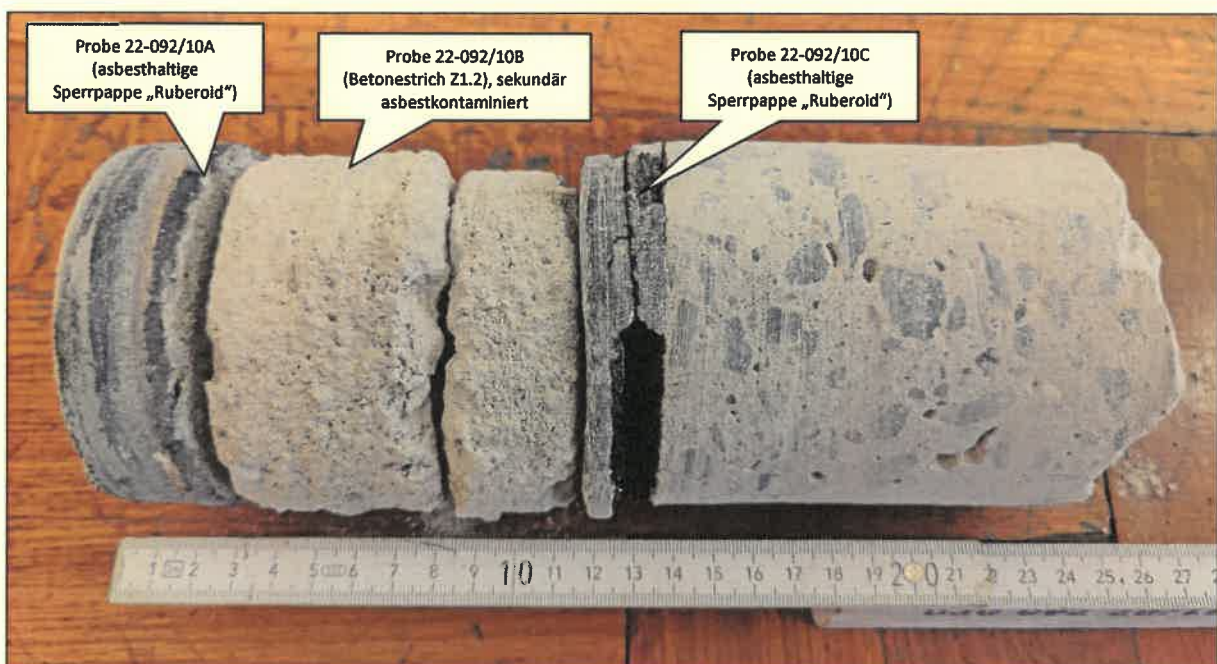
Anbau NW, Sportmethodisches Kabinett R 177 – Kernbohrung 22-092/10 zeigt Fußbodenaufbau mit Holzparkett über asbesthaltiger Sperrpappe „Ruberoid“, asbestkontaminiertem Betonestrich Z 1.2, mehrlagigem Paket aus asbesthaltigen Sperrpappen „Ruberoid“ und asbestkontaminiertem Rohbeton.
